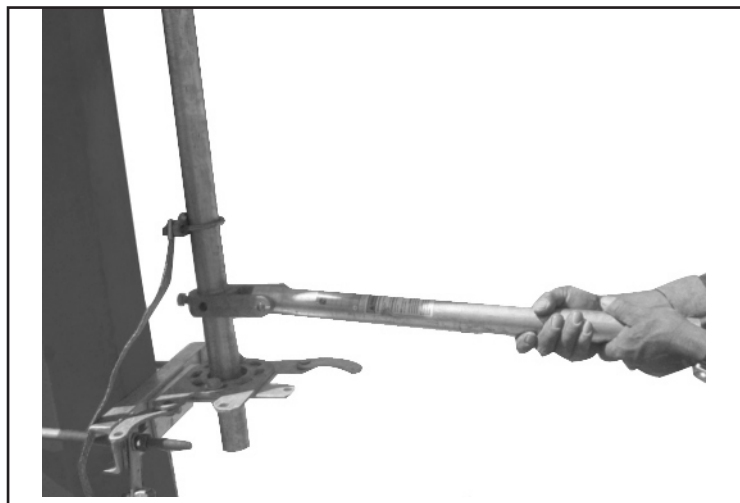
Ajuste de la placa de tope para posición de cerrado.
